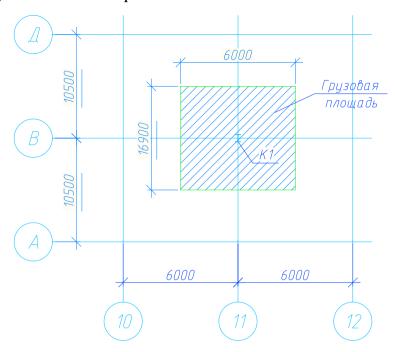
Грузовая площадь колонны К1 от покрытия
